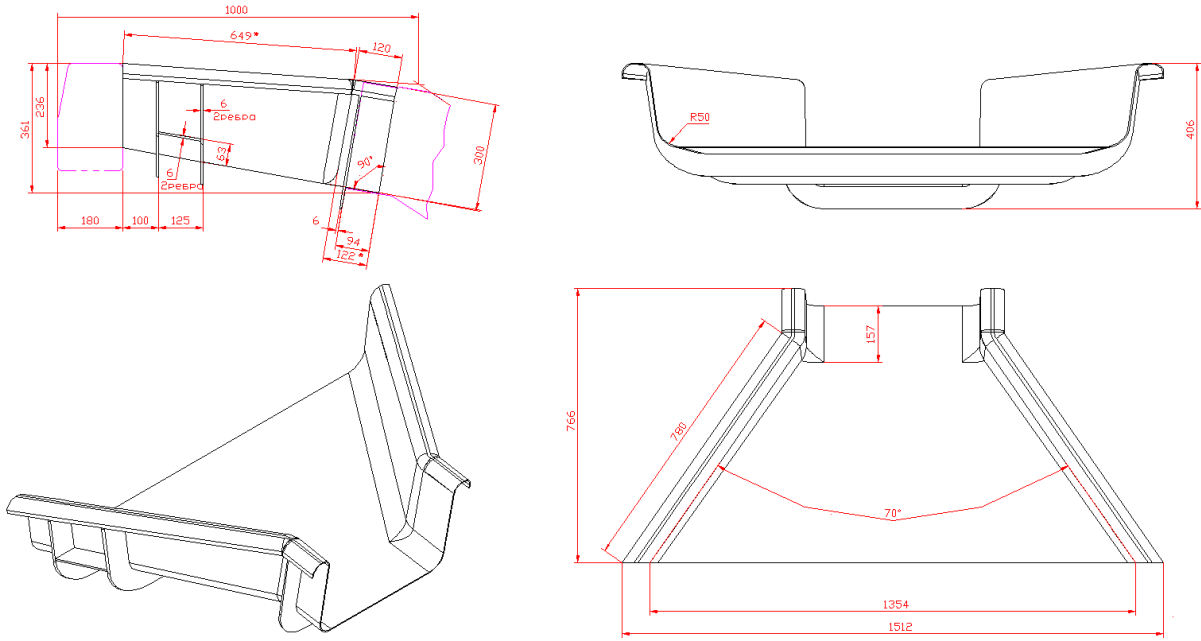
ВД-004.2-4 Быстроток верхний двухсторонний прямой 300x500 мм для обочины 1 м. Масса – 8 кг
